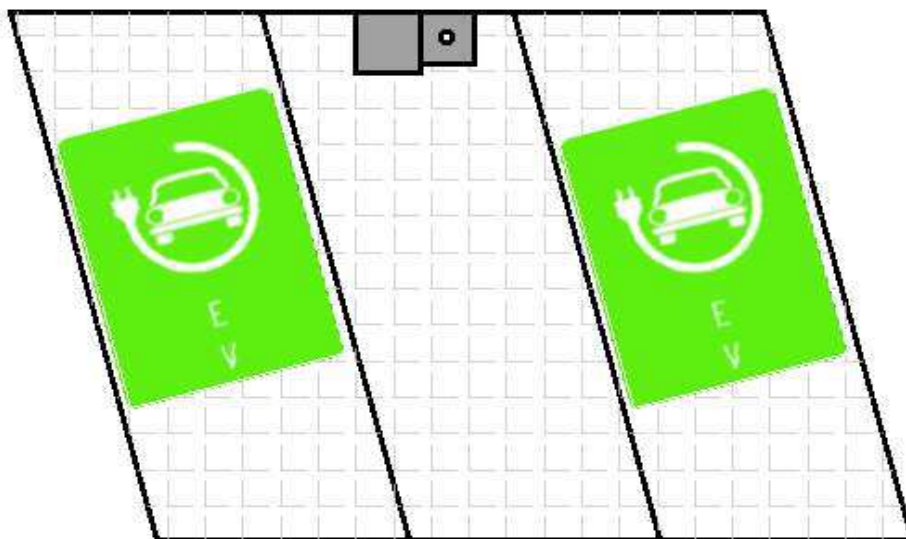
Amenajare stație de reîncărcare cu parcare în spic
